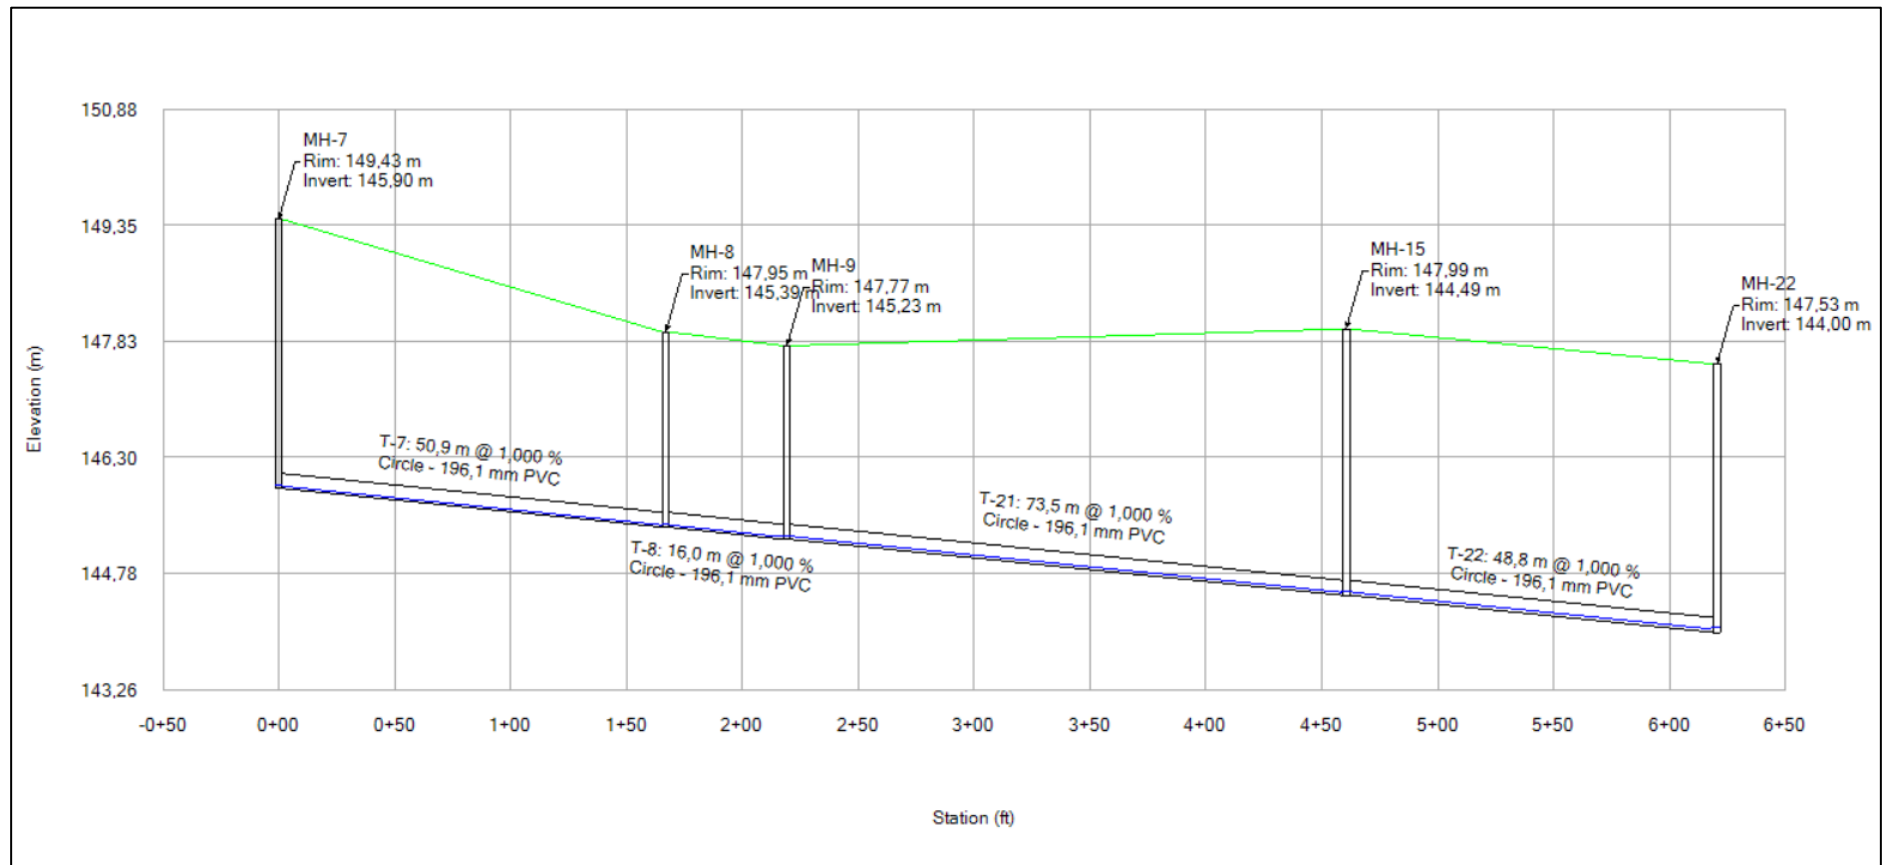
Perfil longitudinal, cámara de bombeo, pz22-descarga final
